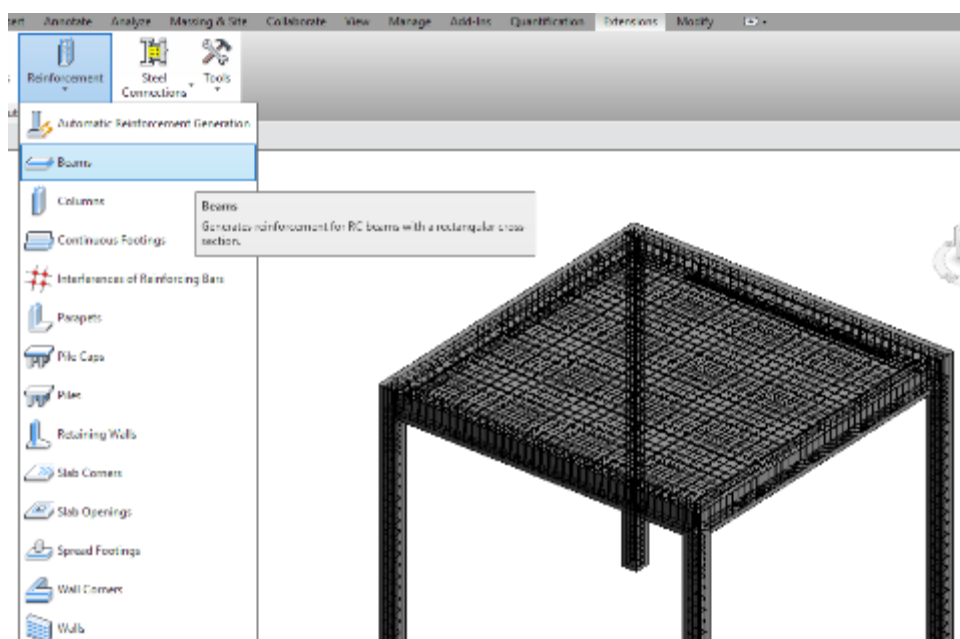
Extensão para Armadura de elementos estruturais em Revit
